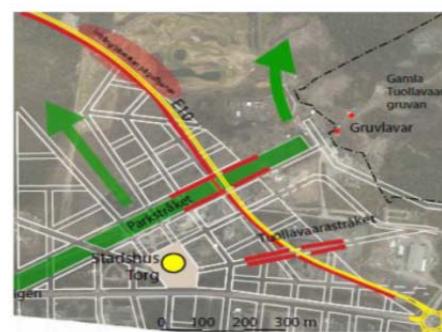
E10:ans sträckning i nya centrum enligt Trafikverkets arbetsplan.
